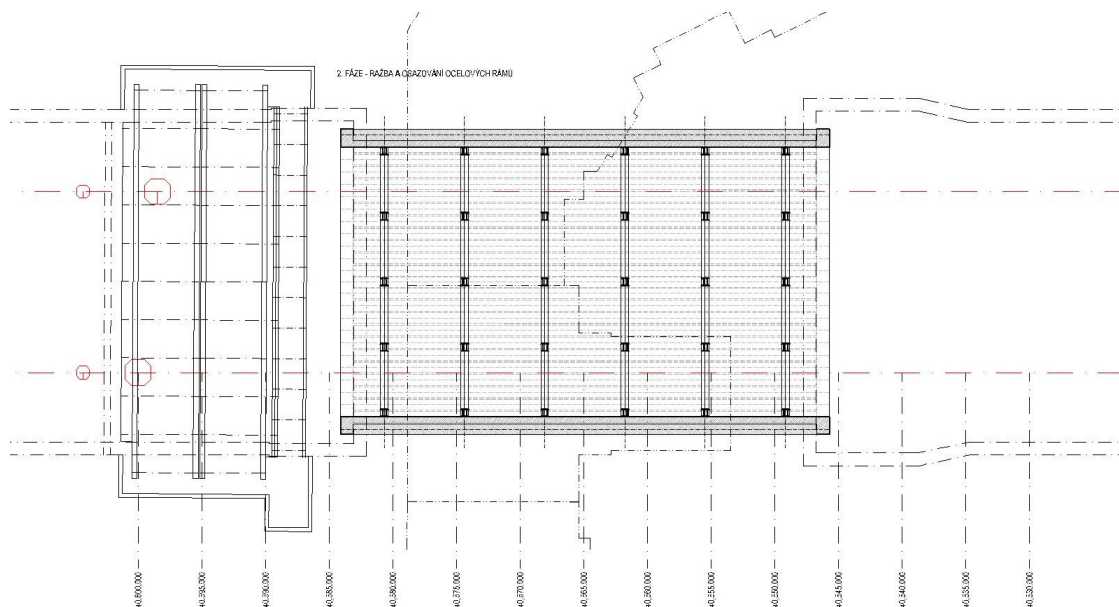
Varianta 2 - Postup výstavby - Pipe roofing
